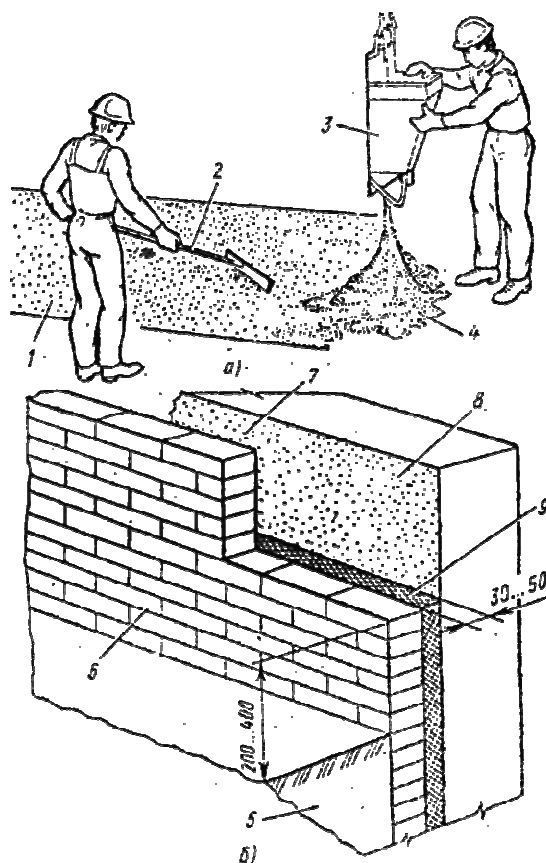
Защита наружной литой гидроизоляции кирпичной кладкой:
